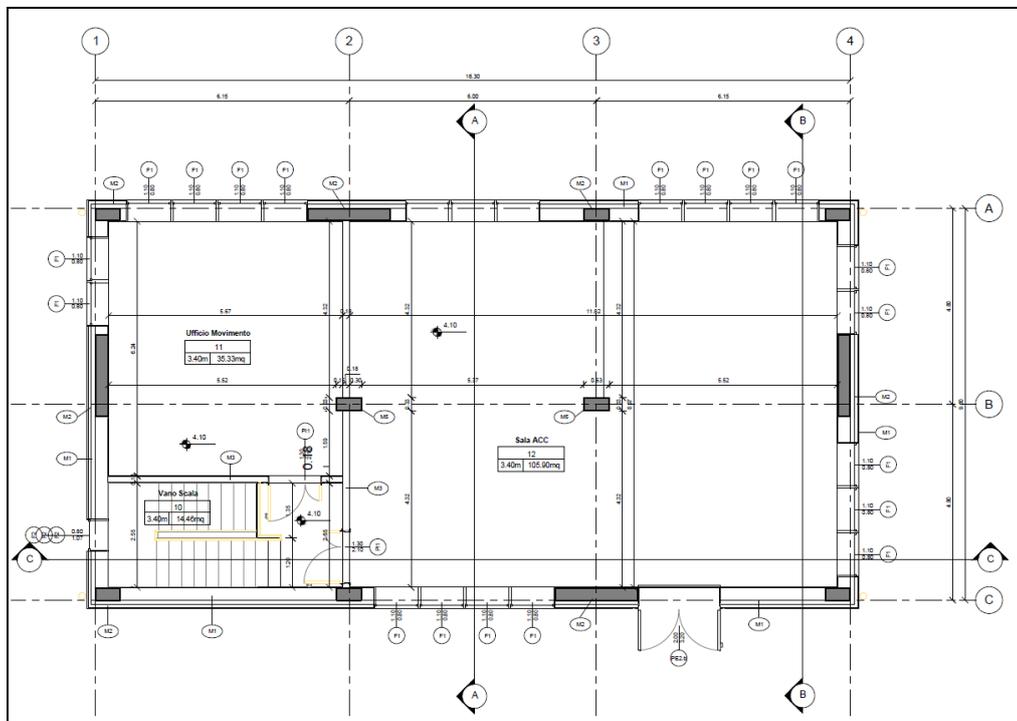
PPM di Pieve Emanuele. Pianta piano Primo.
